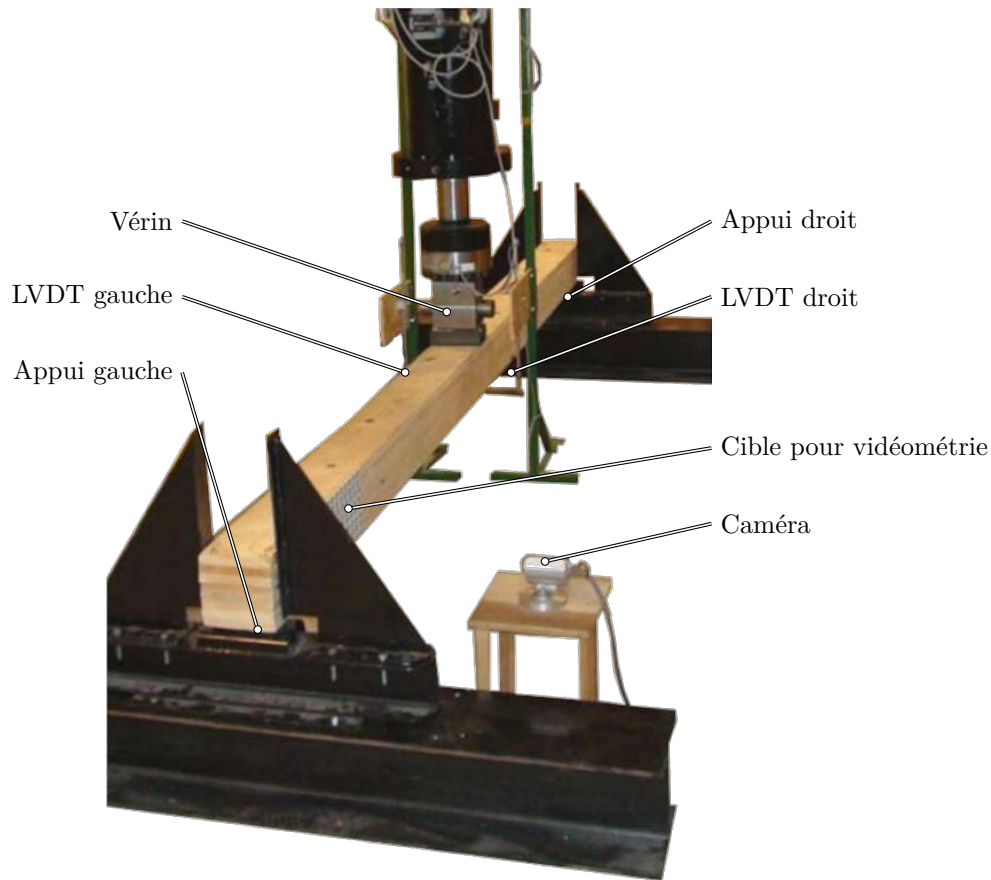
Dispositif expérimental pour les essais en flexion 3 points des poutres reconstituées par tourillons soudés
